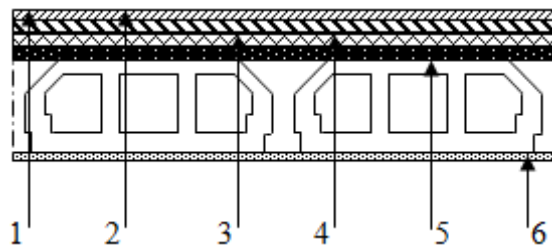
Détail des constituants du plancher terrasse accessible.
